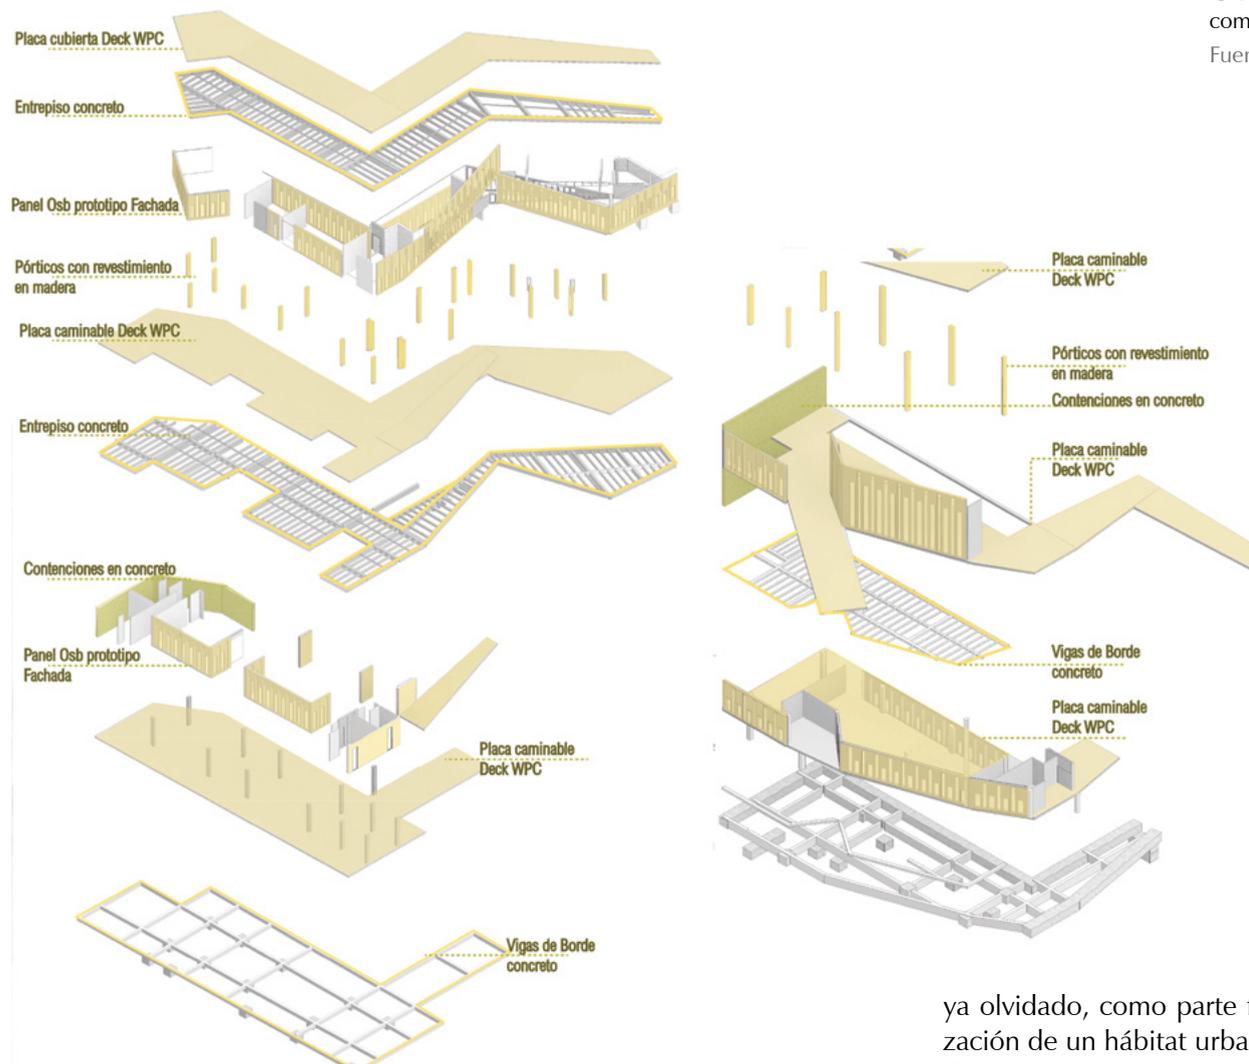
Sistema a porticado con revestimientos en madera para fachadas.
